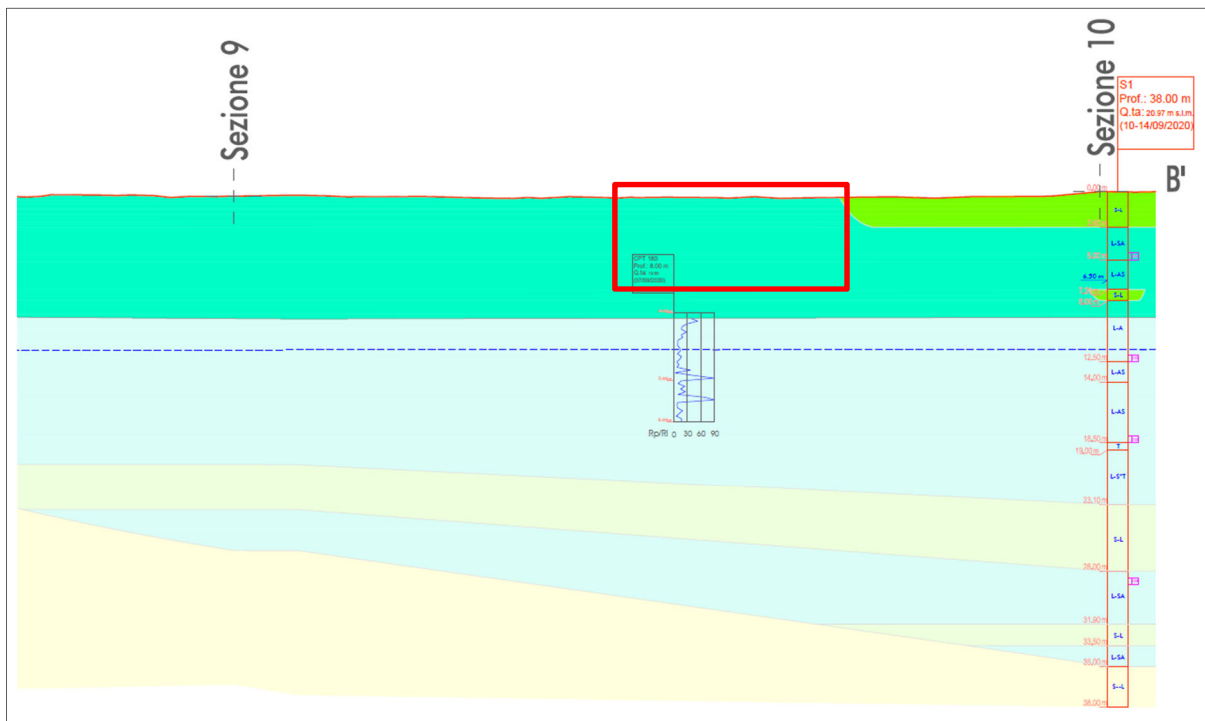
Sezione longitudinale del tratto del tratto soggetto a rialzo e adeguamento arginale. Il rettangolo rosso individua la posizione di installazione dei gabbioni metallici lato campagna.
